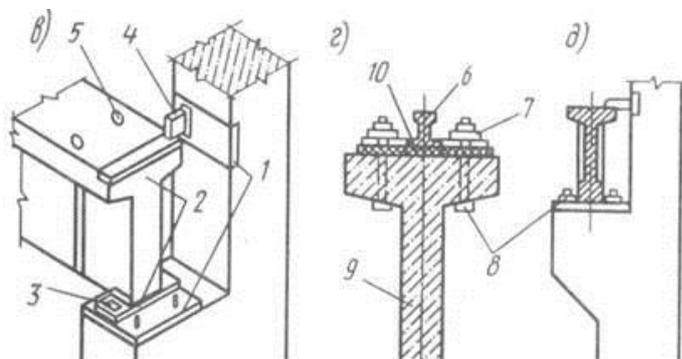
Железобетонные подкрановые балки: в — опирание подкрановой балки на колонну (общий вид); г— крепление рельса к балке; д — крепление балки к колонне (сечение); 1 — закладные детали колонны; 2 — то же, подкрановой балки; 3 — стальная планка (приваривается к опорной закладной детали подкрановой балки); 4 — стальная накладка; 5 — отверстия для крепления рельса; 6— рельс; 7 — резиновая прокладка; 8 — болт; 9 — балка; 10 — стальные лапки-прижимы [4].
